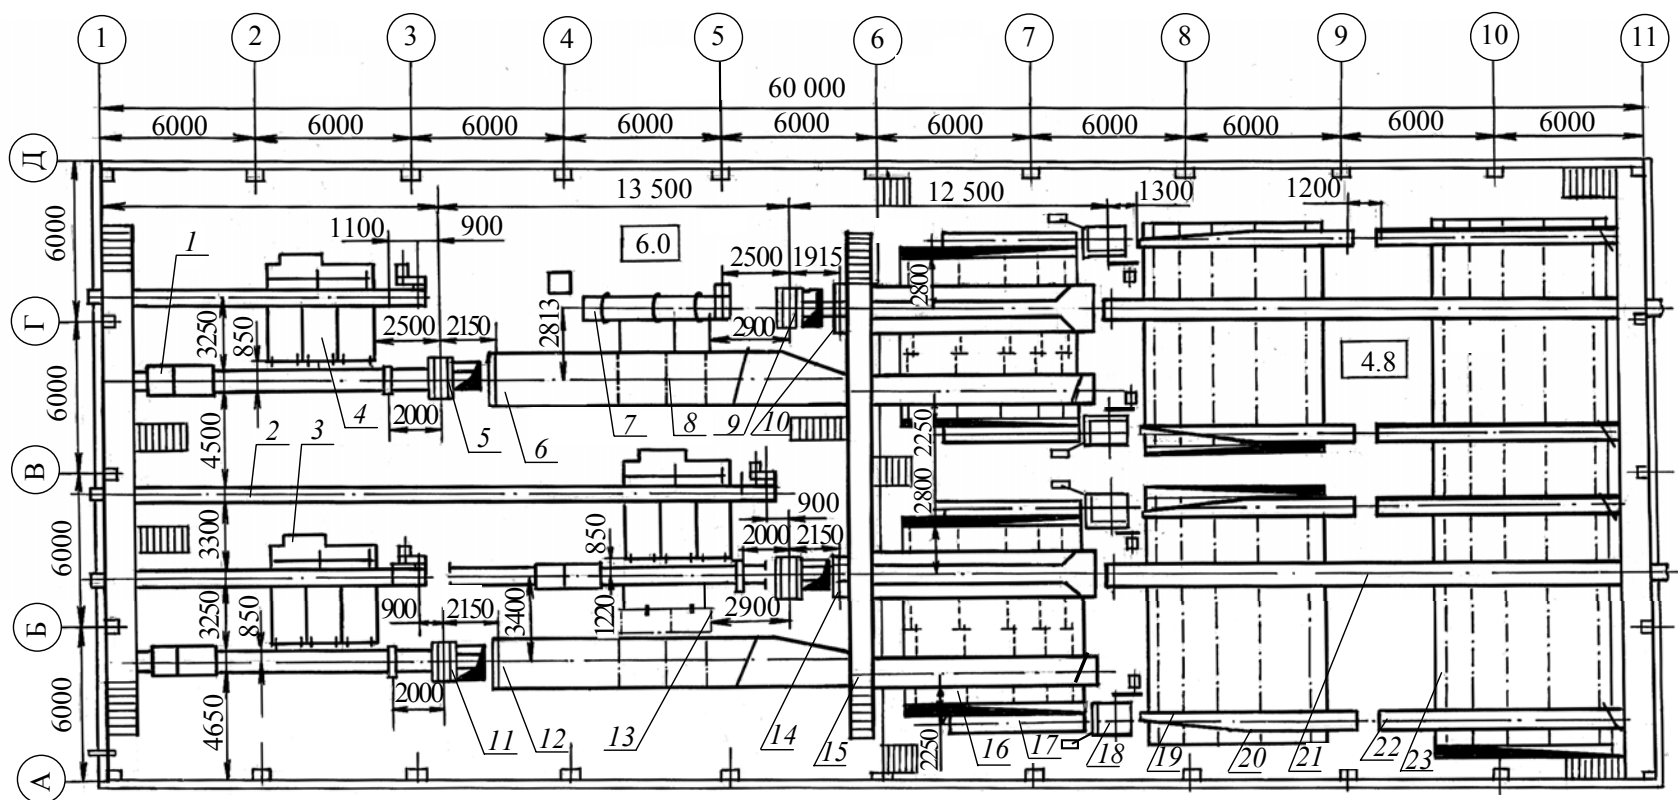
Схема размещения оборудования на втором этаже в четырехэтажном лесопильном цехе:
